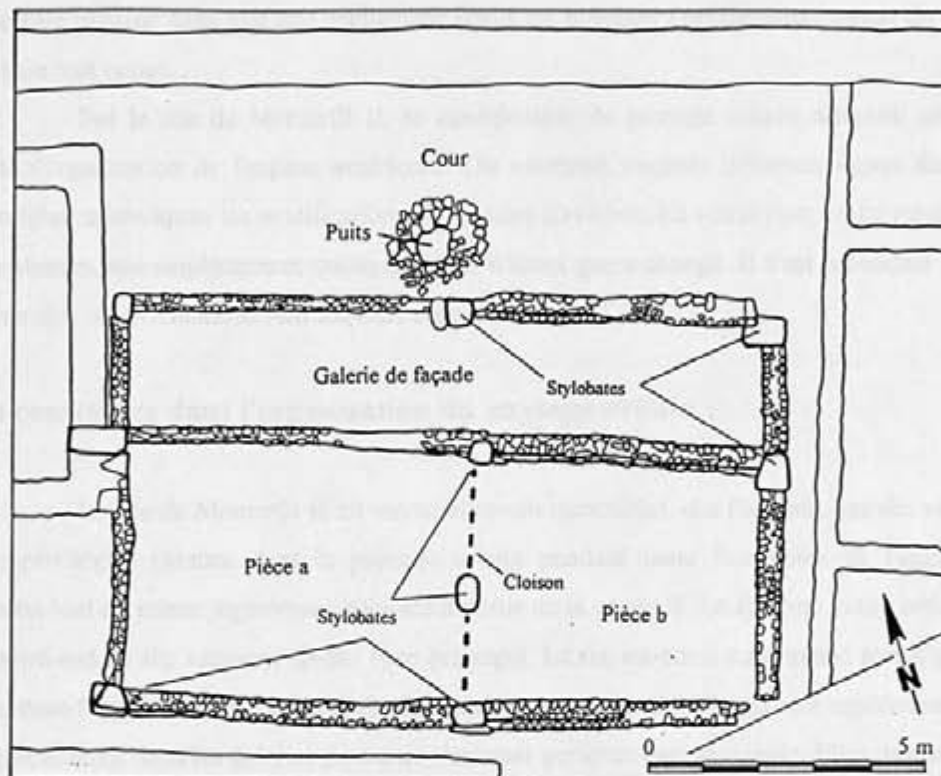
Plan du bâtiment dit "à stylobates" au centre du quartier sud;
